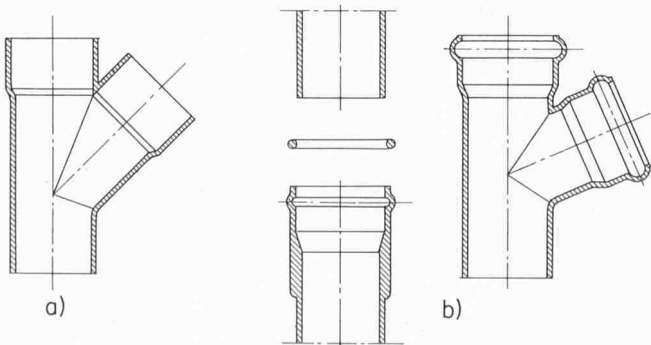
Abwasserinstallationen aus PVC werden vorwiegend mit Formteilen und Rohren auf der Baustelle zusammengebaut. Die Verbindung erfolgt durch Kleben oder Stecken. Bei den Steckverbindungen wird die Dichtung durch einen eingelegten Gummiring übernommen. a) Abzweig mit Klebemuffen (Dynadur), b) Rohr und Rohrformteile mit «Universal»-Muffen für Kleb- und Steckverbindung (LKA-UM)
